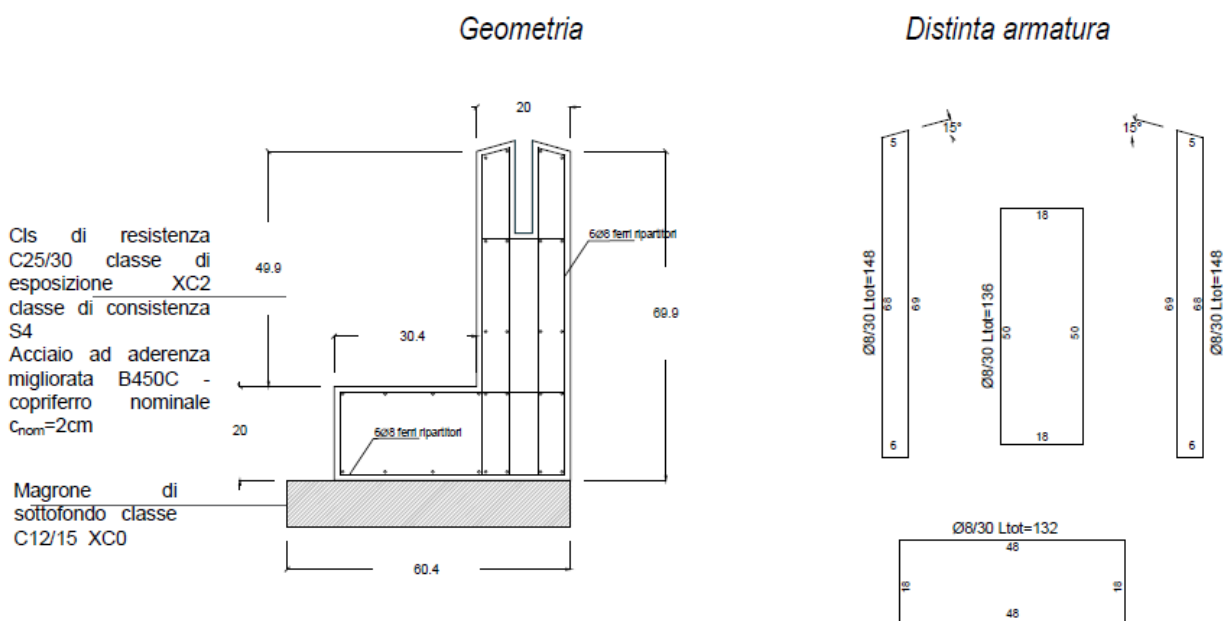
Tipologia n.02 – muretto di recinzione in c.a.
